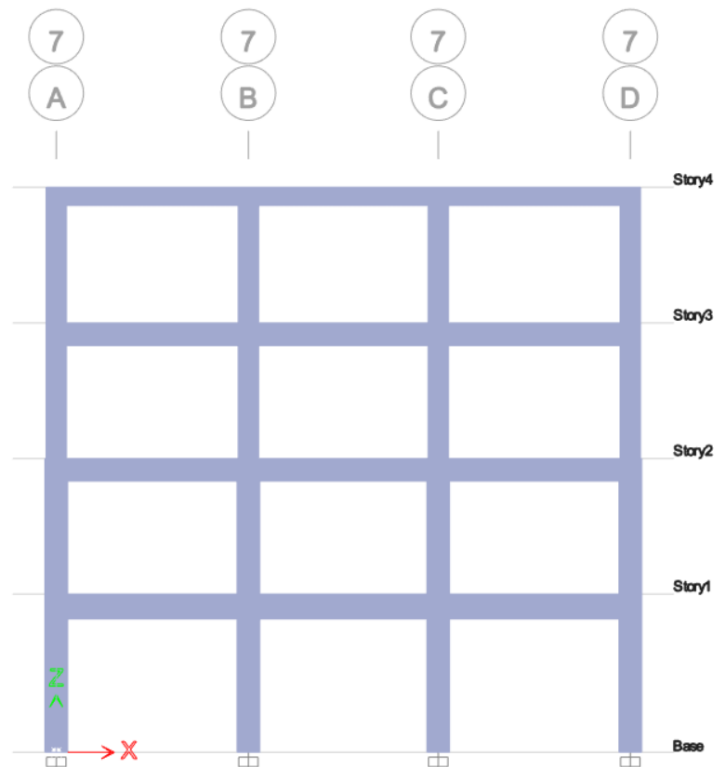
Modelado estructural de la edificación tipo (ET), alzado transversal (Eje 7) (Autores)
